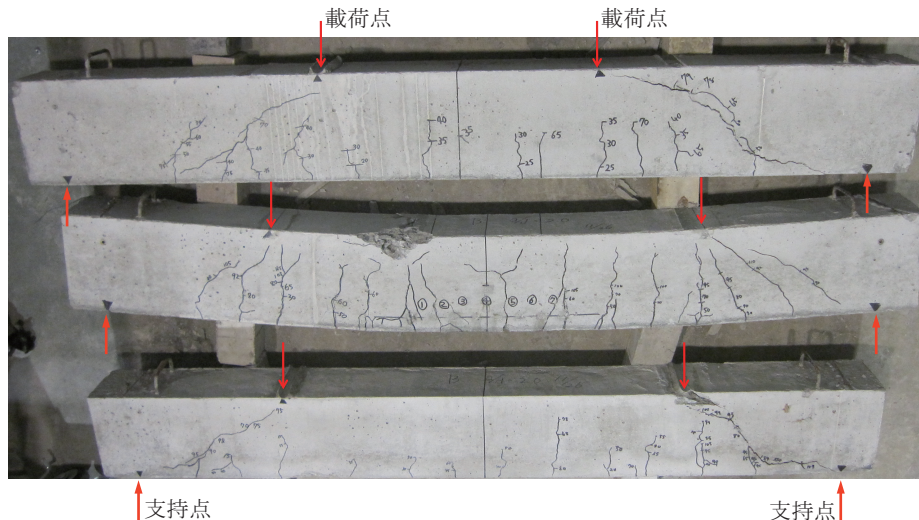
異なる載荷点および配筋量より曲げモーメントを受ける鉄筋コンクリート単純梁のひび割れへの影響
